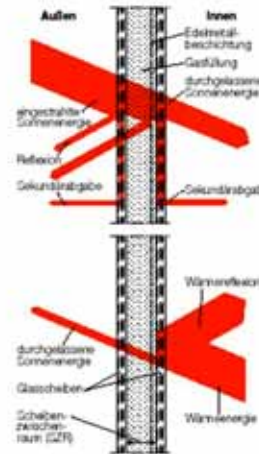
Wärmedurchgang durch ein Fenster mit Wärmeschutzglas (schematische Darstellung)
